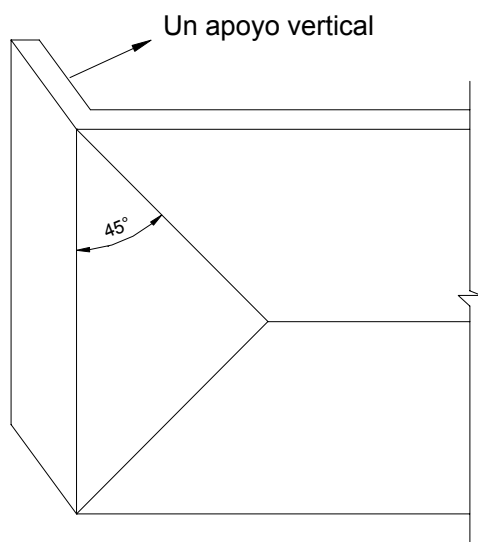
Esquema de colapso simplificado para muros con un apoyo vertical.
